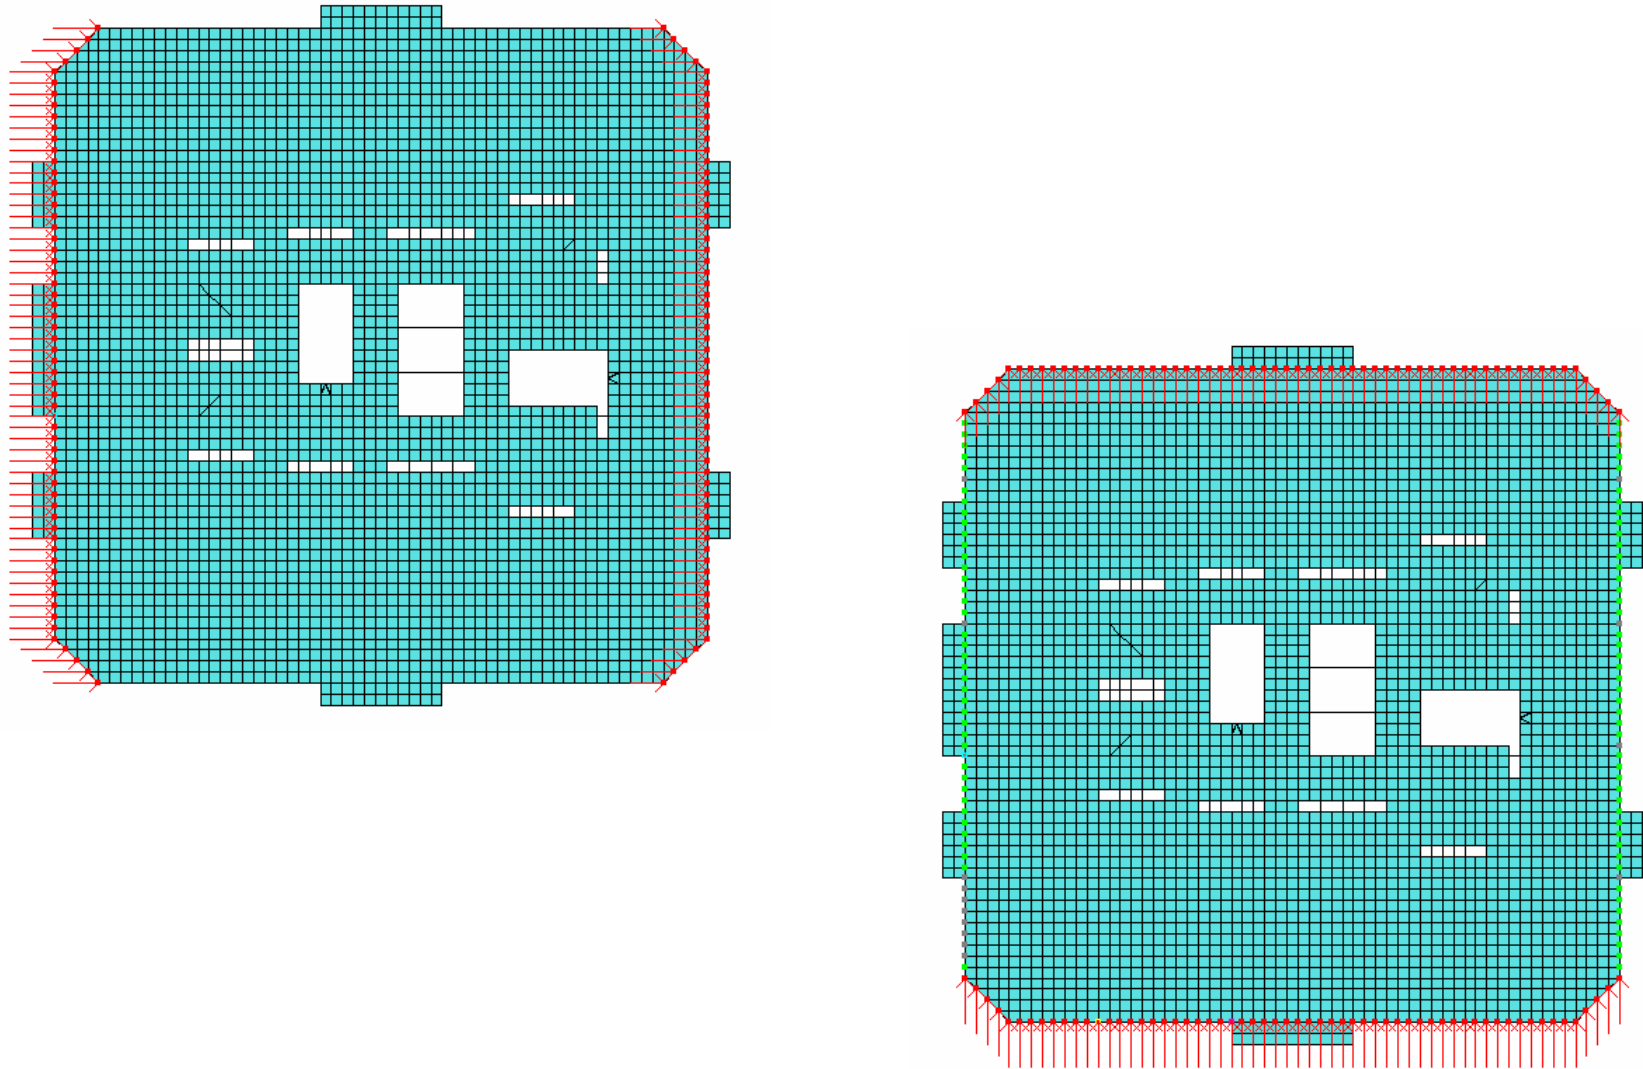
Действие ветровых нагрузок на перекрытие типового этажа
